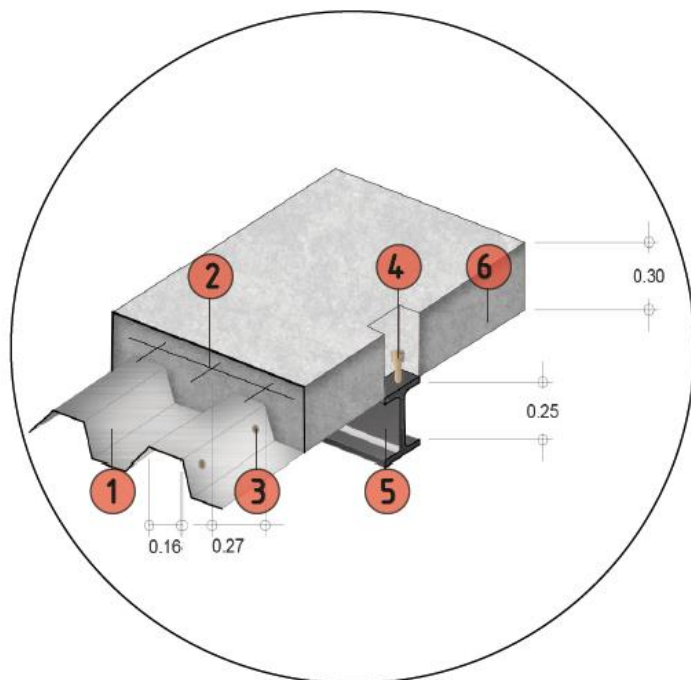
Detalle de piso steeldeck. Elaboración propia.
